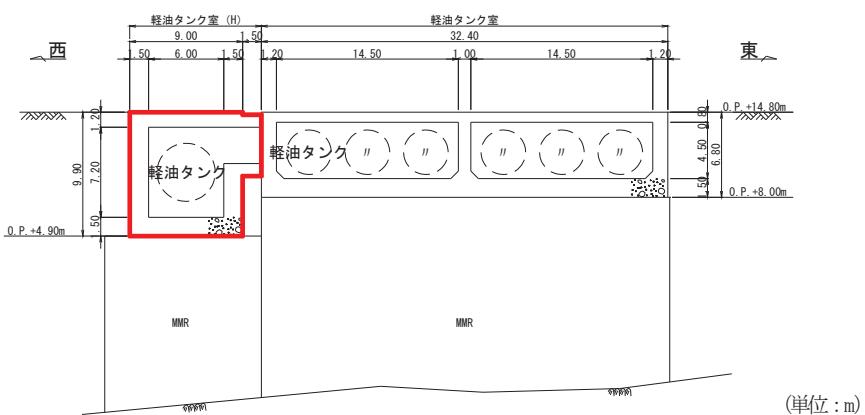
軽油タンク室 (H) 断面図 (B-B)
